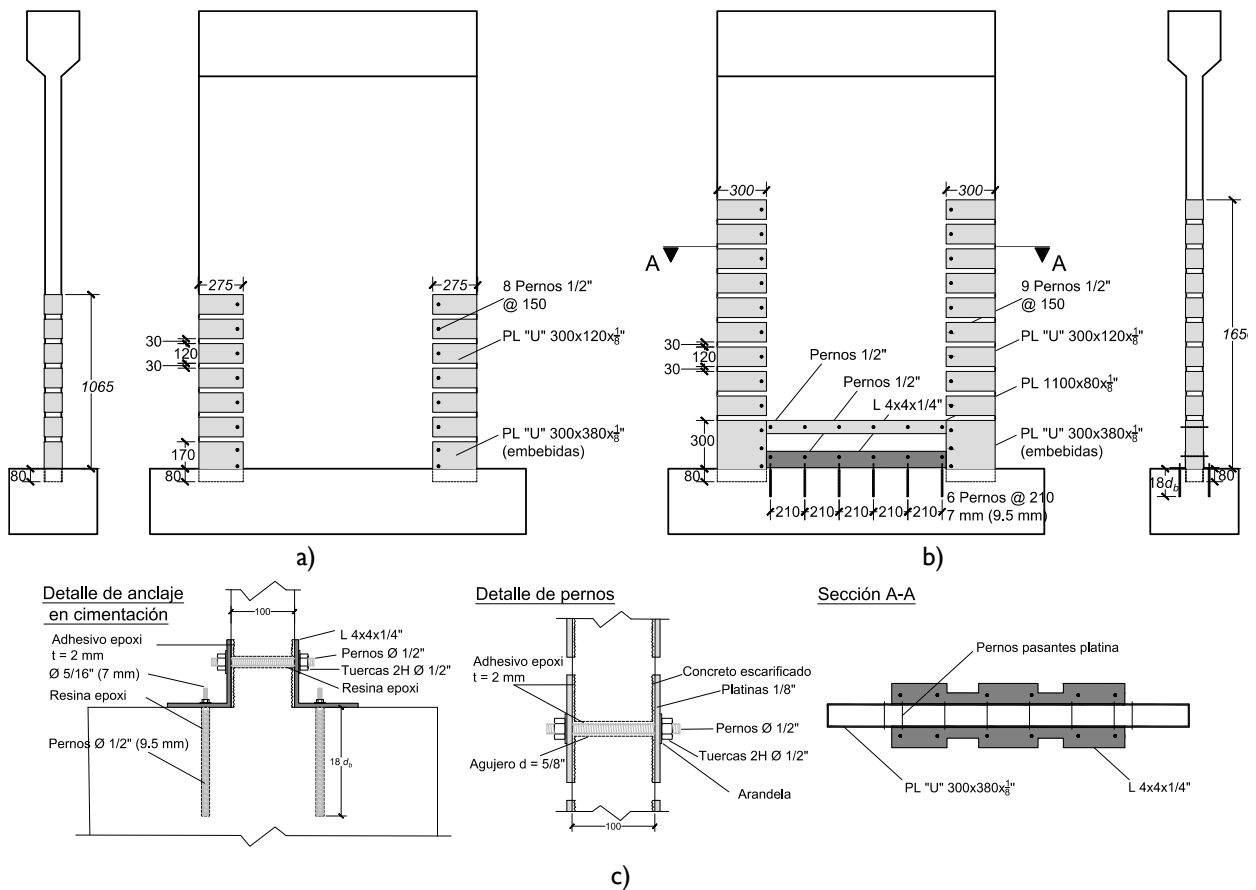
Propuesta de reforzamiento de los muros M7RR y M8RR [1]. Dimensiones en mm
